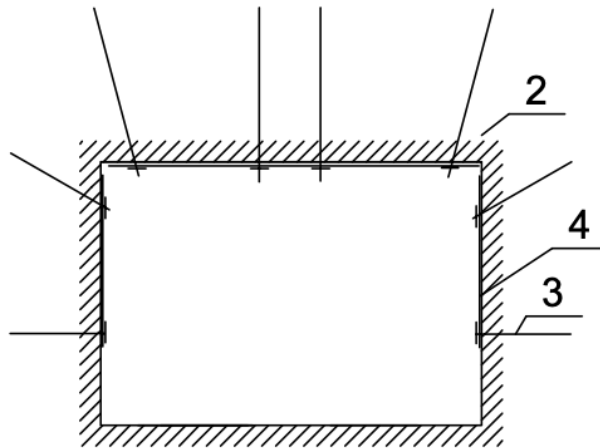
Поперечное сечение проводимой выработки на первом этапе
